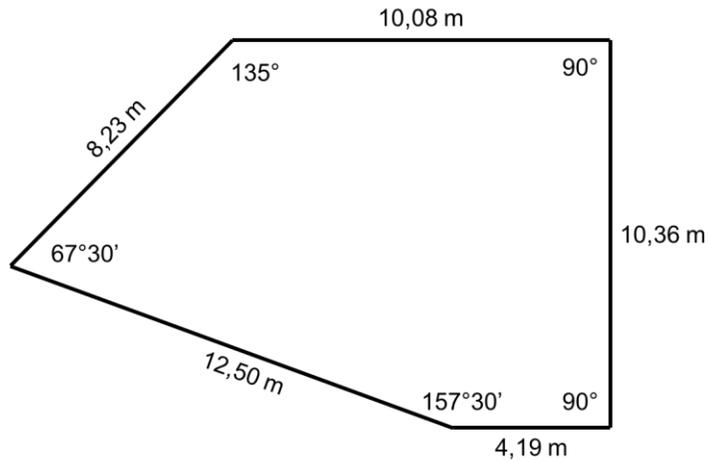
Exemplo de levantamento planimétrico. Fonte: Autoria própria.
